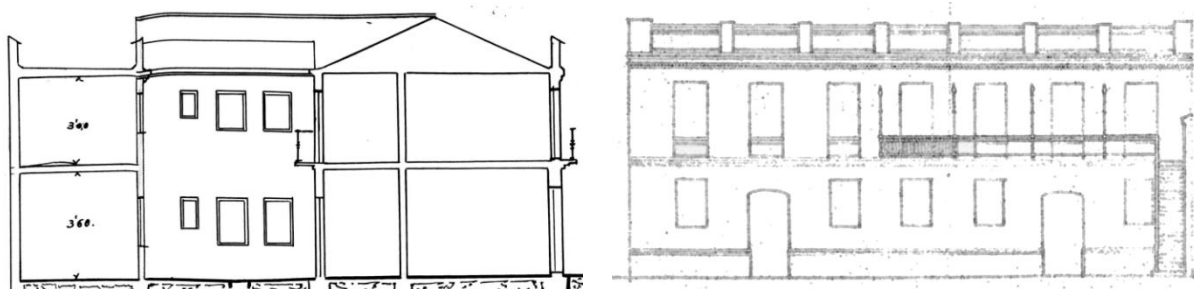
A la izquierda, plano transversal del nº 25 de la calle Caridad, con las estancias añadidas a la izquierda; a la derecha fachada de la casa construida en el nº 55 de la calle Granada destinada a cuartos y residencia. AVM, Secretaría, signaturas 25-263-15 y 25-263-30.
